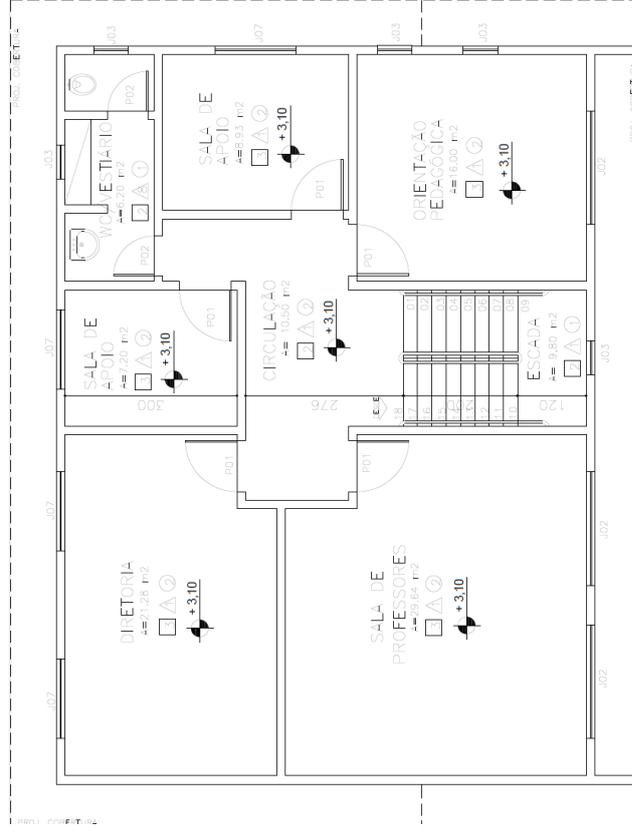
ESCOLA J – QUADRA E 1º PAVIMENTO
